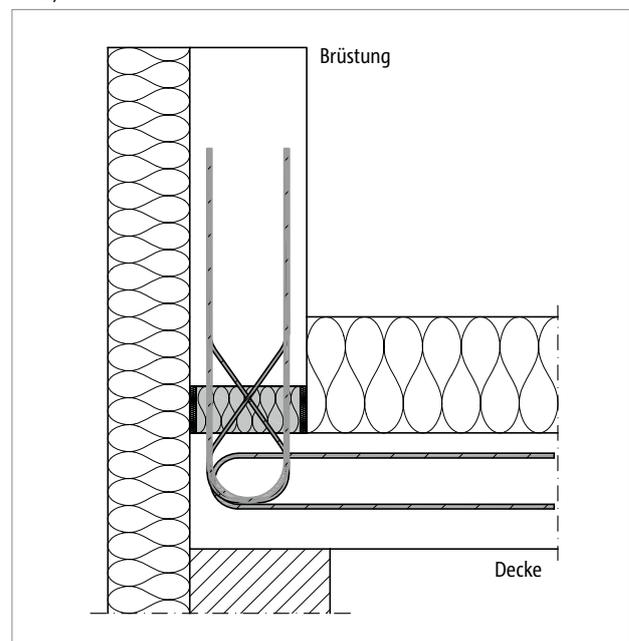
Schöck Isokorb® T Typ A: Anschluss einer Brüstung (T Typ A-MM2)
